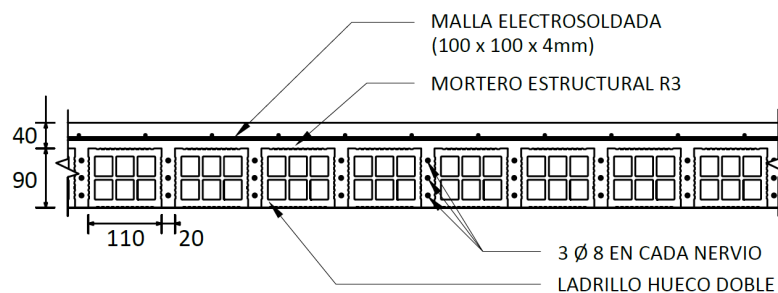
Corte longitudinal tipo de cubierta. 25x25x10cm – Armado 3Ø8 en cada nervio – Malla electrosoldada 10x10x3cm o 15x15x34cm Fuente: Elaboración propia
